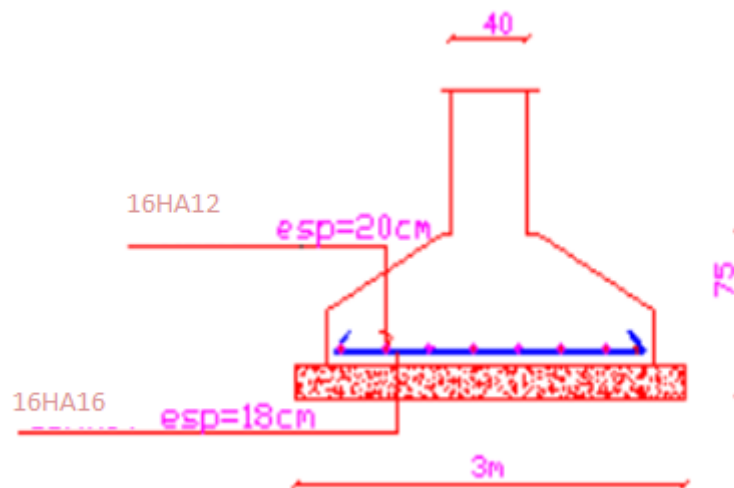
Schéma de ferrailage de la semelle filante selon y-y
